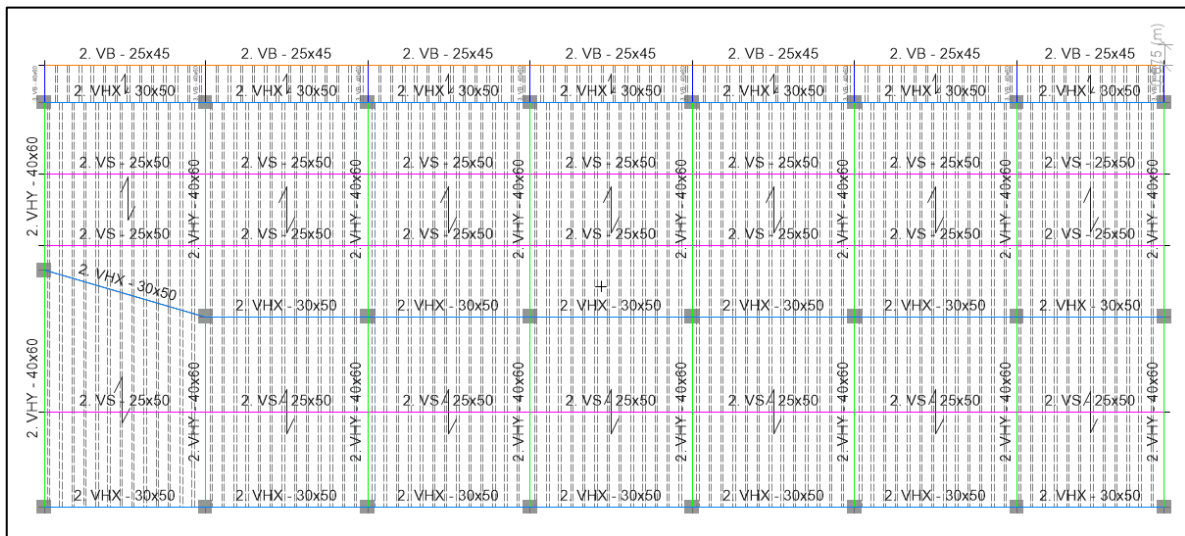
Planta Tipo P1 a Cubierta, N.E. +3.60 m a N.E. +14.40 m
